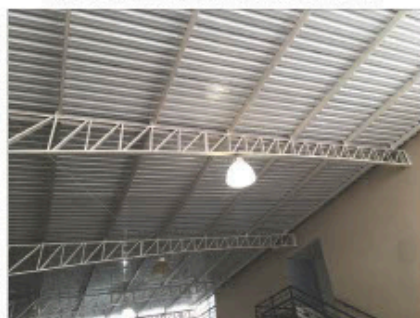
Apoio das treliças inclinadas na estrutura de concreto
